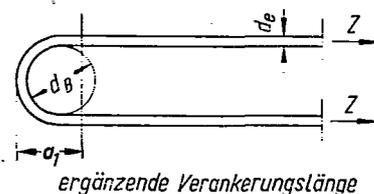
Verankerung mit Schlaufe (Draufsicht)
